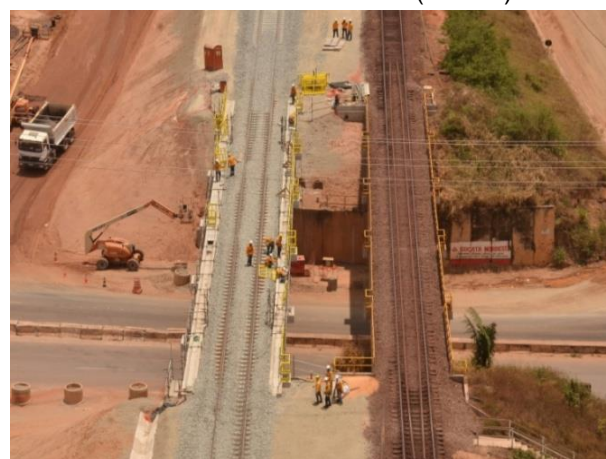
Vista aérea do viaduto ferroviário BR135 (Loc 0-2).
